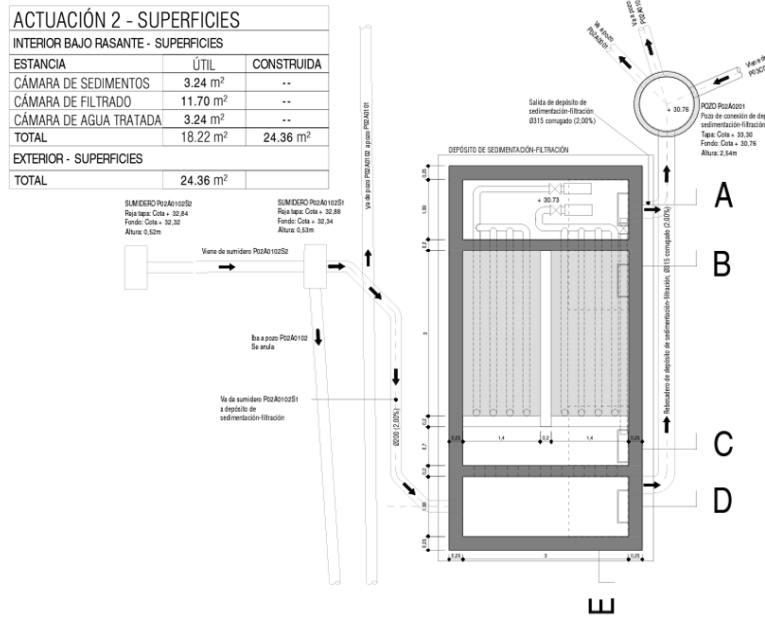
Esquema en planta del sistema de filtro de arena tipo Washington con dimensiones superficiales.
